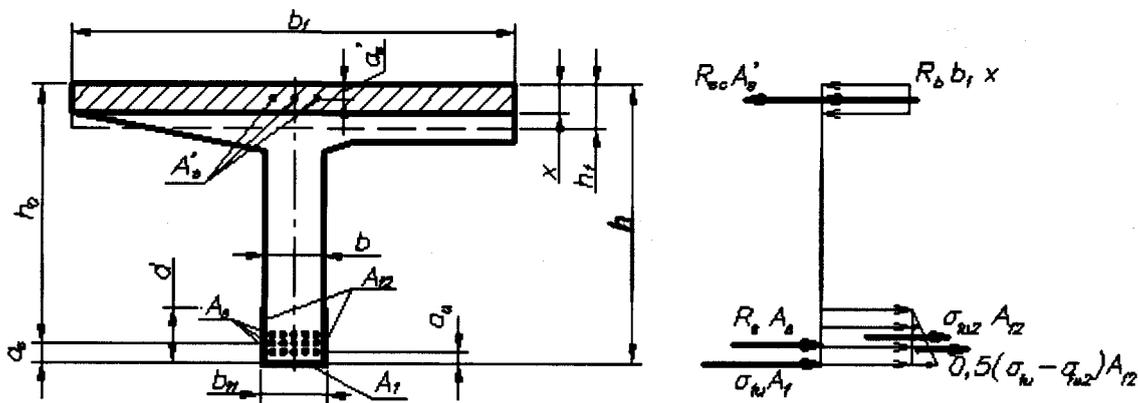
Расчетное сечение тавровой балки при расположении границы сжатой зоны в плите;
